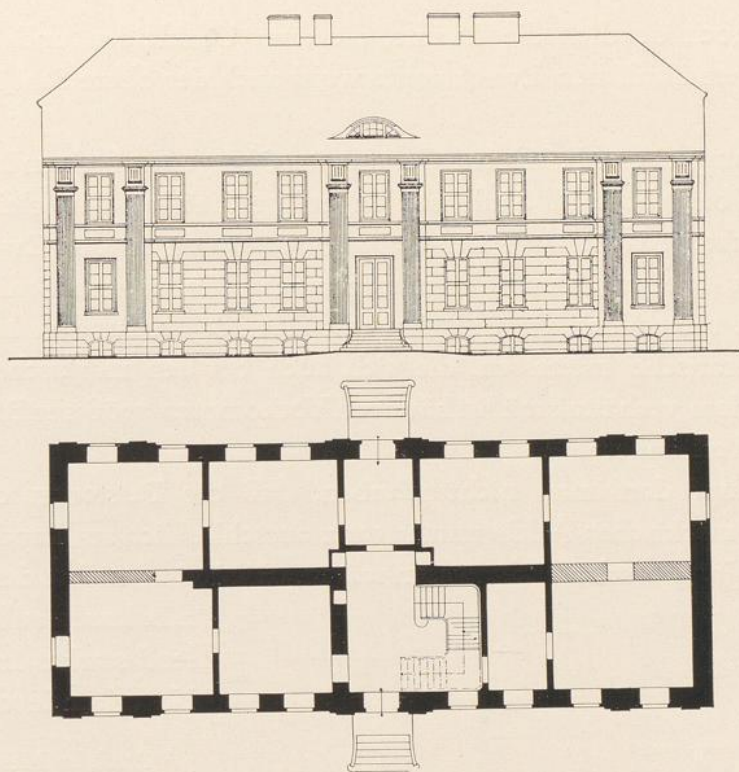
Görbitsch. Rekonstruktionsversuch der Fassade. Erdgeschoß
